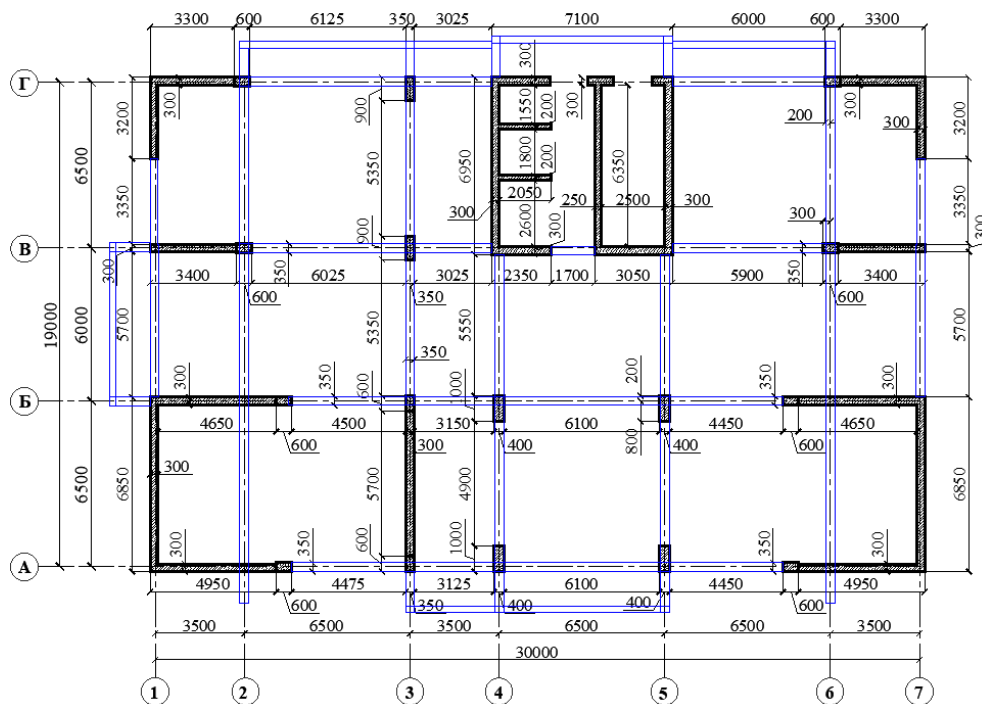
Схема расположения вертикальных элементов зданий без учёта сейсмоизоляции.
